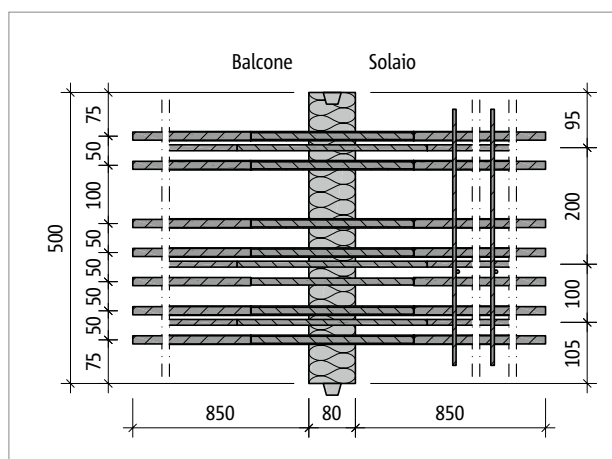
Schöck Isokorb® T tipo K-M13-V1: pianta del prodotto
